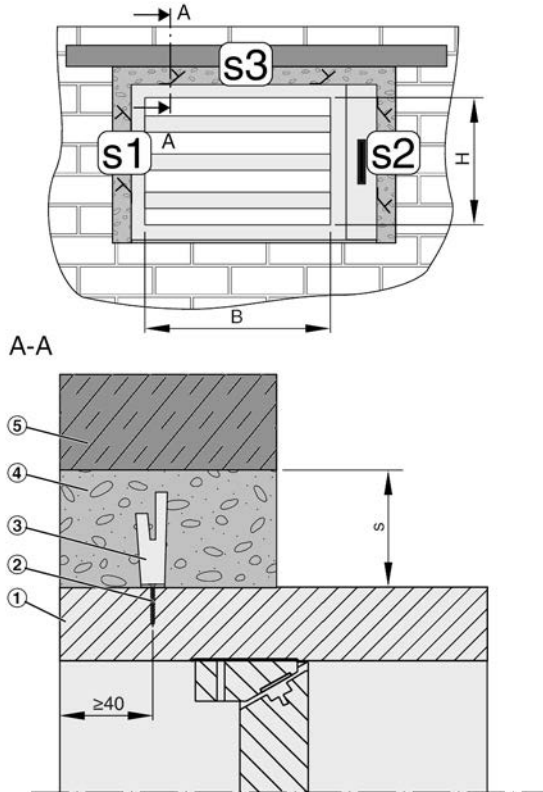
Installazione a base di malta della EK-JZ con linguetta di fissaggio
